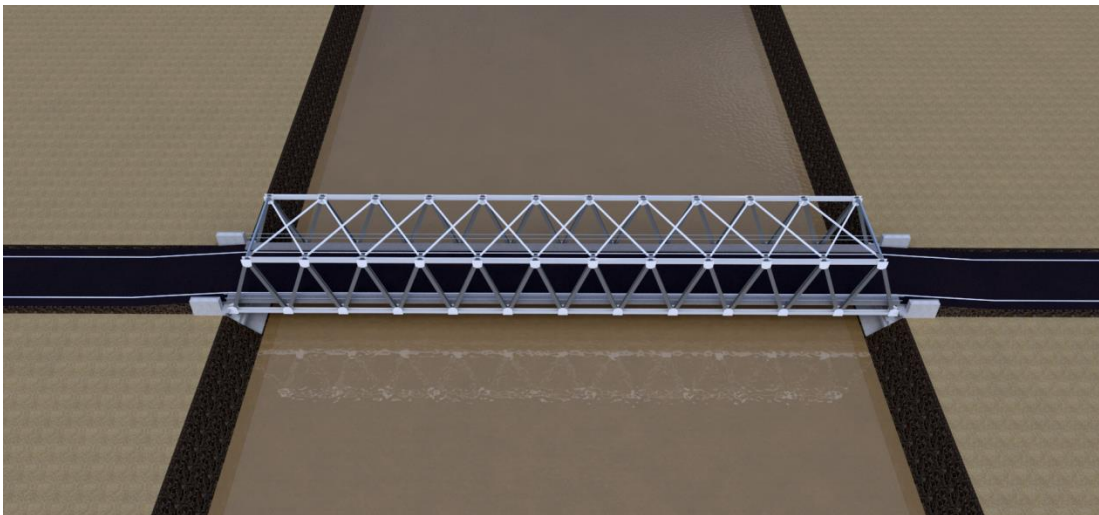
Rangka baja sementara dilepas dan rangka baja permanen diturunkan secara bertahap dengan dongkrak
